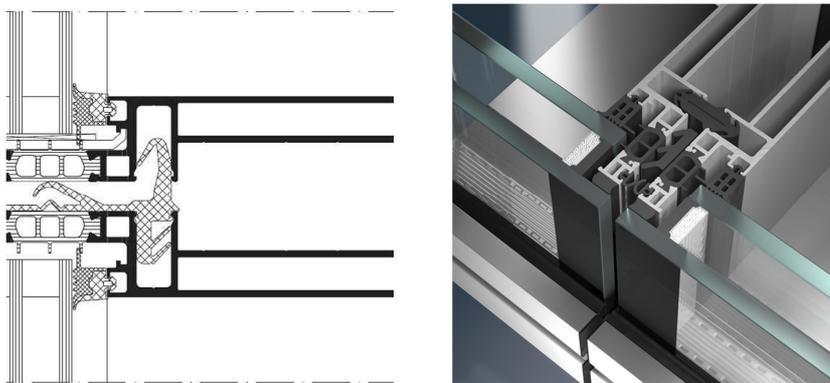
Profilsystem einer Elementfassade<sup>41</sup>
